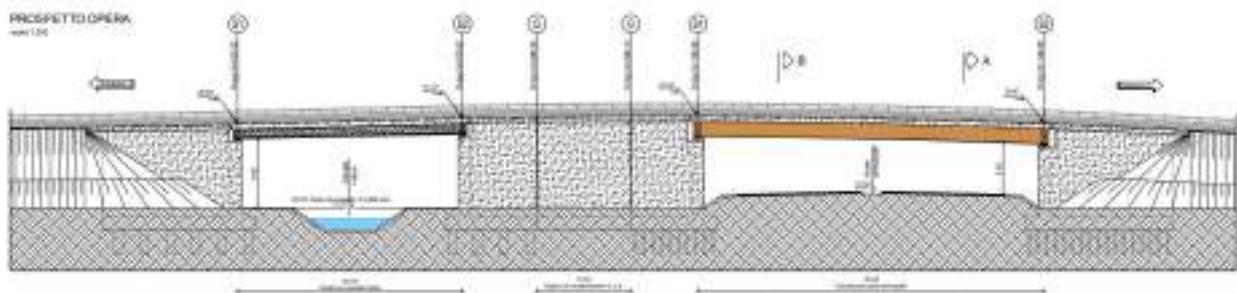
Prospetto del cavalcavia asse principale svincolo Capoterra – Casic.
